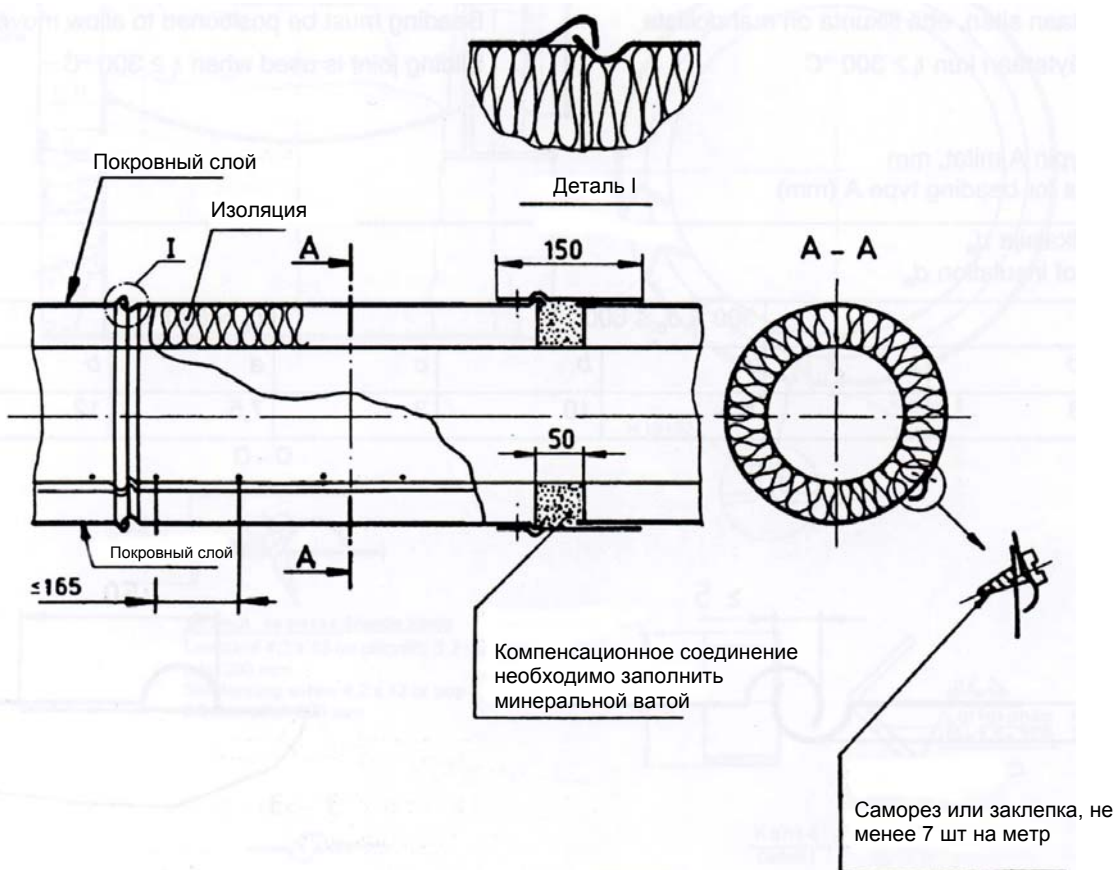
Сборка участка трубопровода с металлическим покровным слоем
